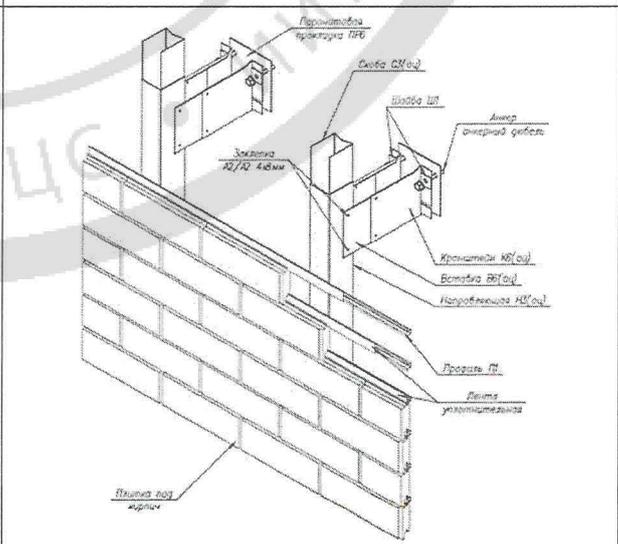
Система с облицовкой плиткой под кирпич на профиль П1 без затирки швов (крепление в межэтажные перекрытия)
